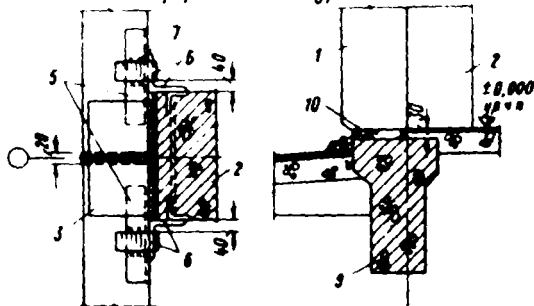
Устройство швов между стеновыми панелями (варианты с упругими прокладками и цементным раствором)
